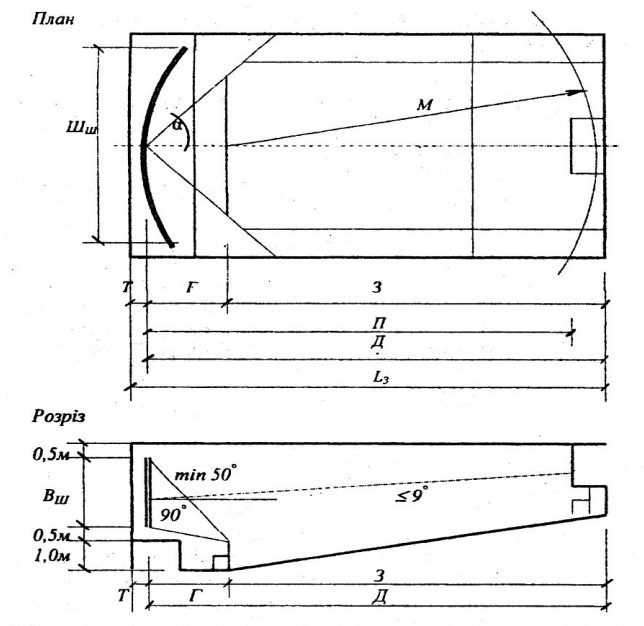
Схеми плану і позовжнього розрізу глядацької зали:
